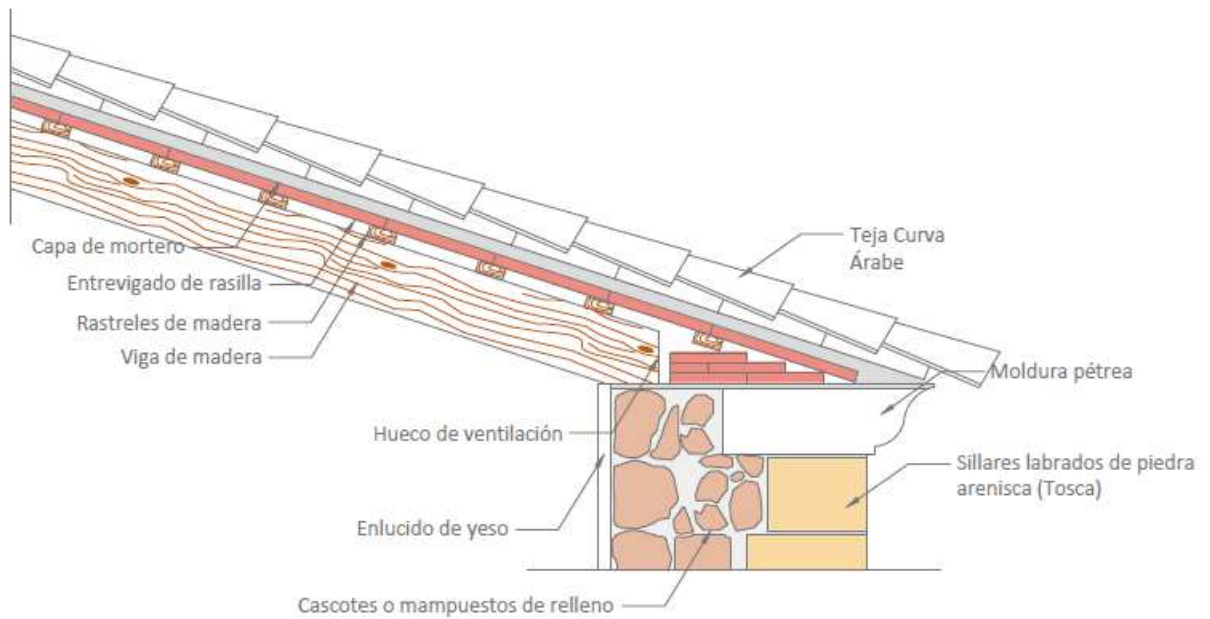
Forjado inclinado bajo cubierta formado por vigas de madera y entrevigado de rasilla. Elaboración propia
